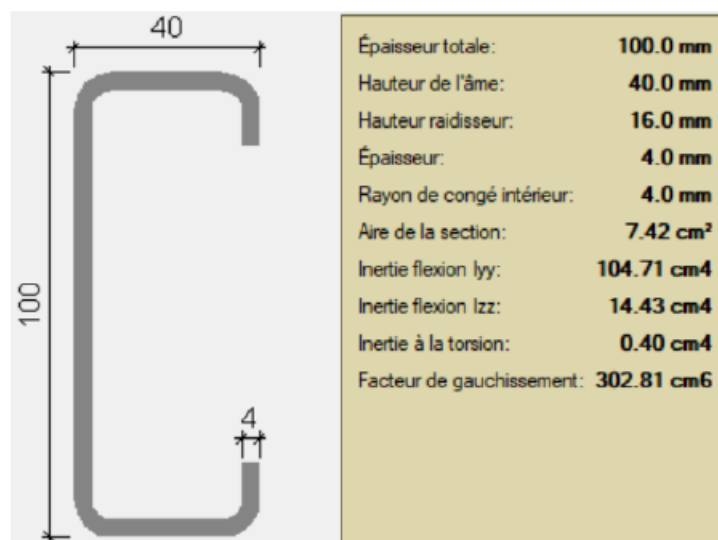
Schéma d'une coupe d'un pieu et ses dimensions (Source : VALECO)
